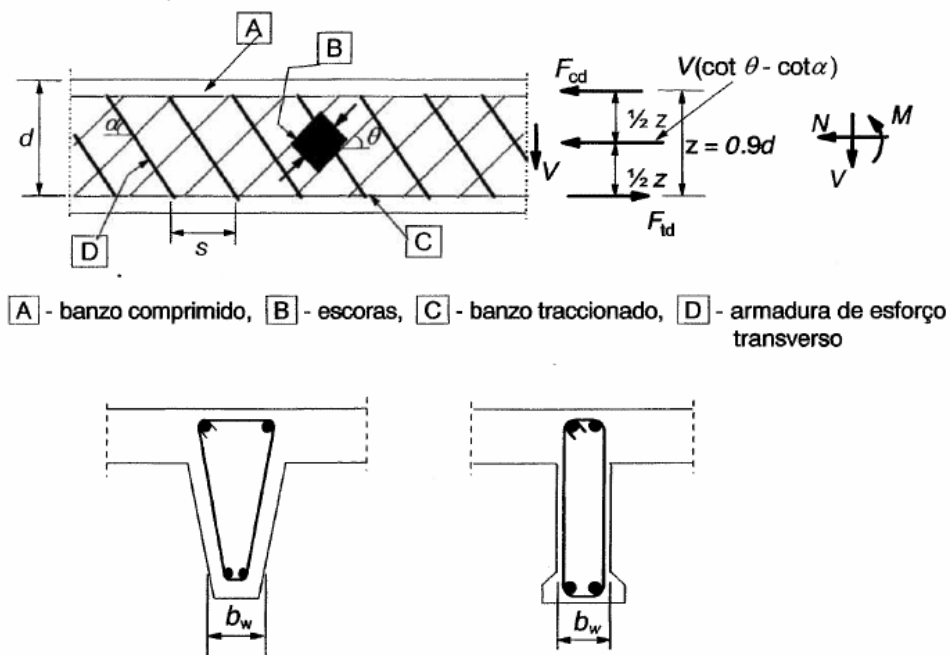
Modelo de treliça e notações para elementos com armaduras de esforço transversal
